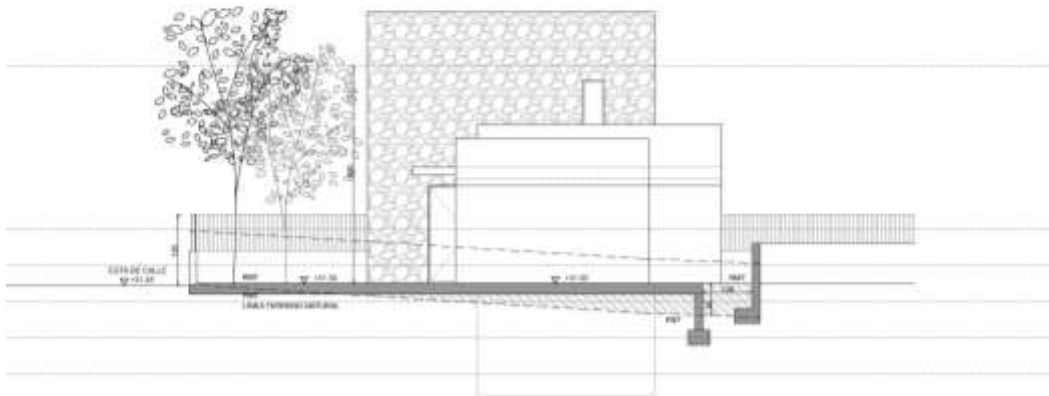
Alzado noroeste. Fuente: proyecto básico y de ejecución.
